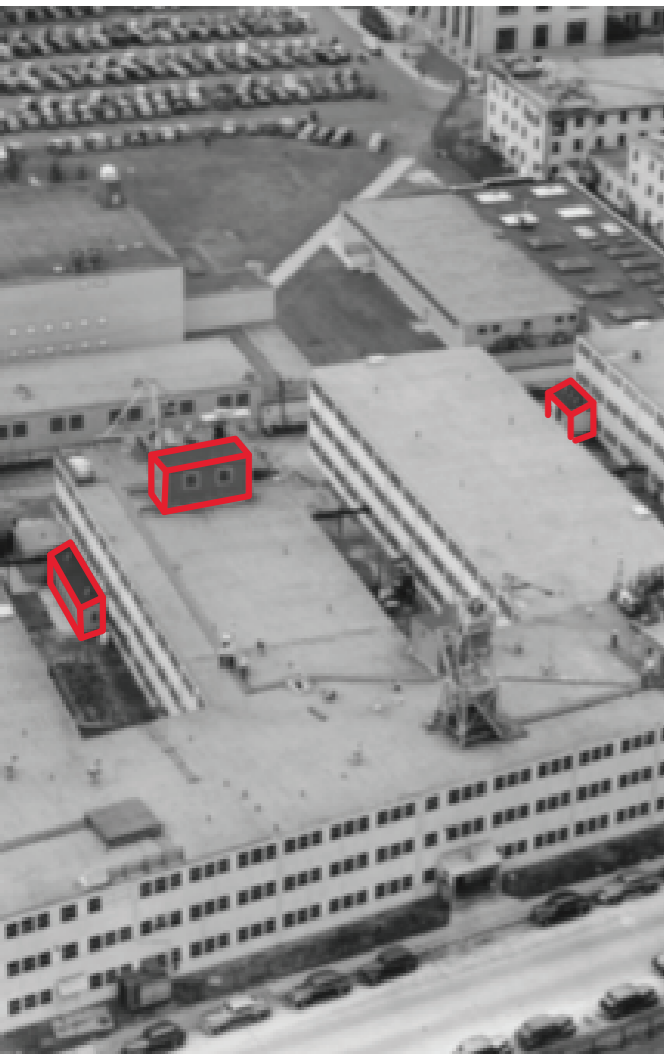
BLOCO CRIADO POSTERIORMENTE NO EDIFÍCIO MIT BUILDING 20
